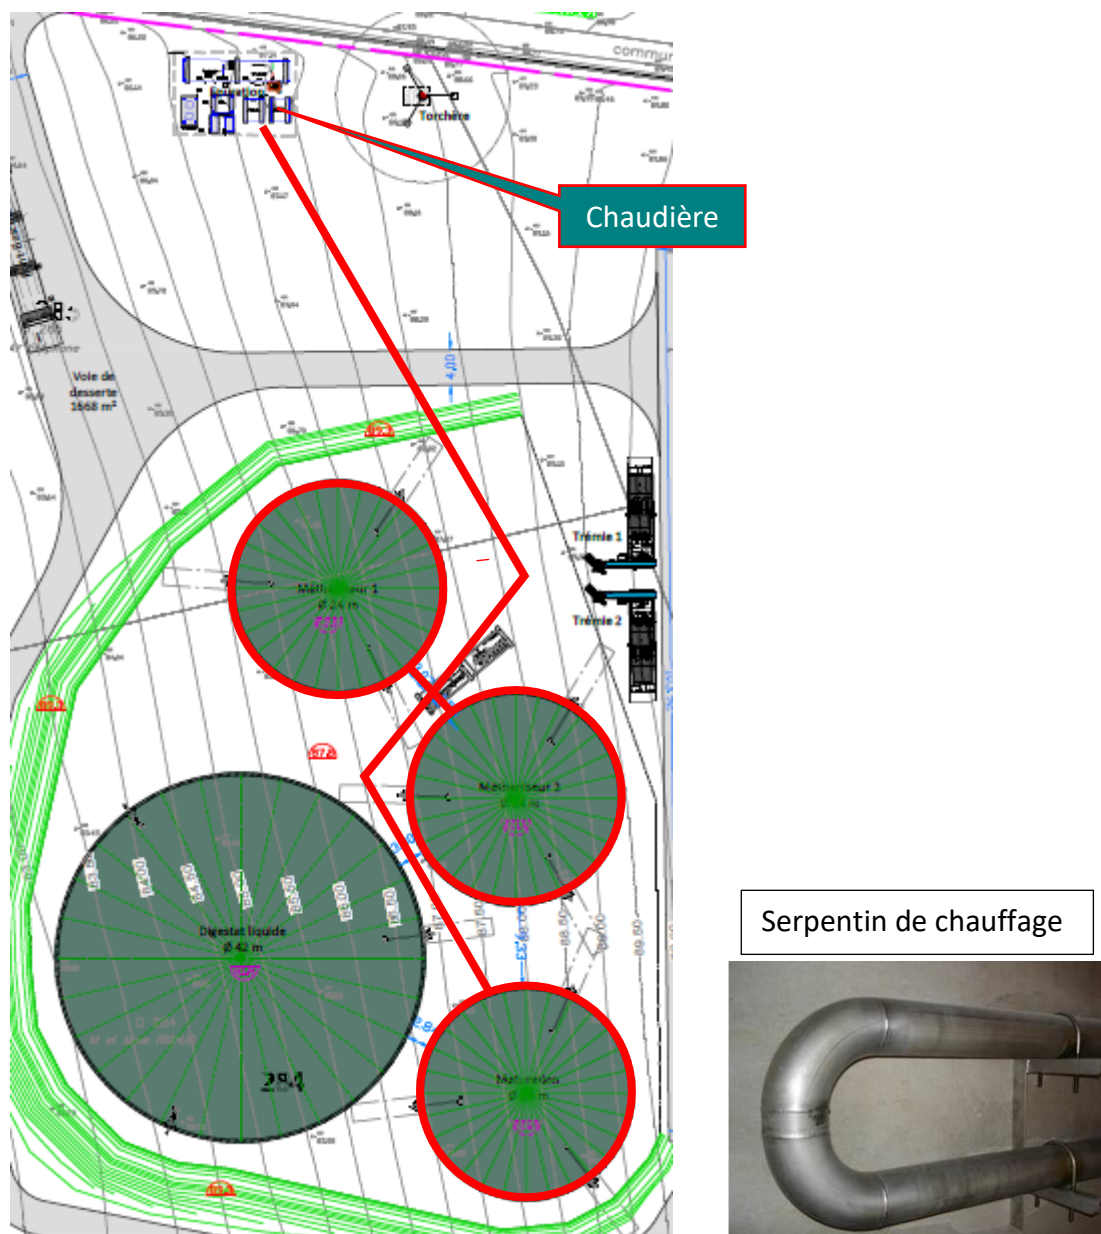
Plan de situation des réseaux de chaleur (réseau en rouge vers la chaudière)
